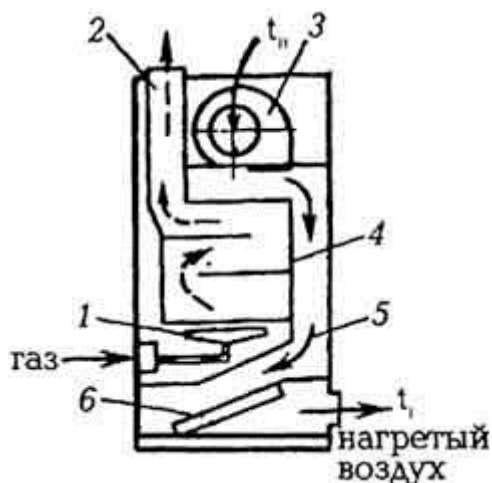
Схема газовоздушного отопительного агрегата: 1 - газовая горелка; 2 - дымоход; 3 - вентилятор; 4 - газовоздушный теплообменник; 5 - теплопроводы (каналы); 6 - воздушный фильтр
